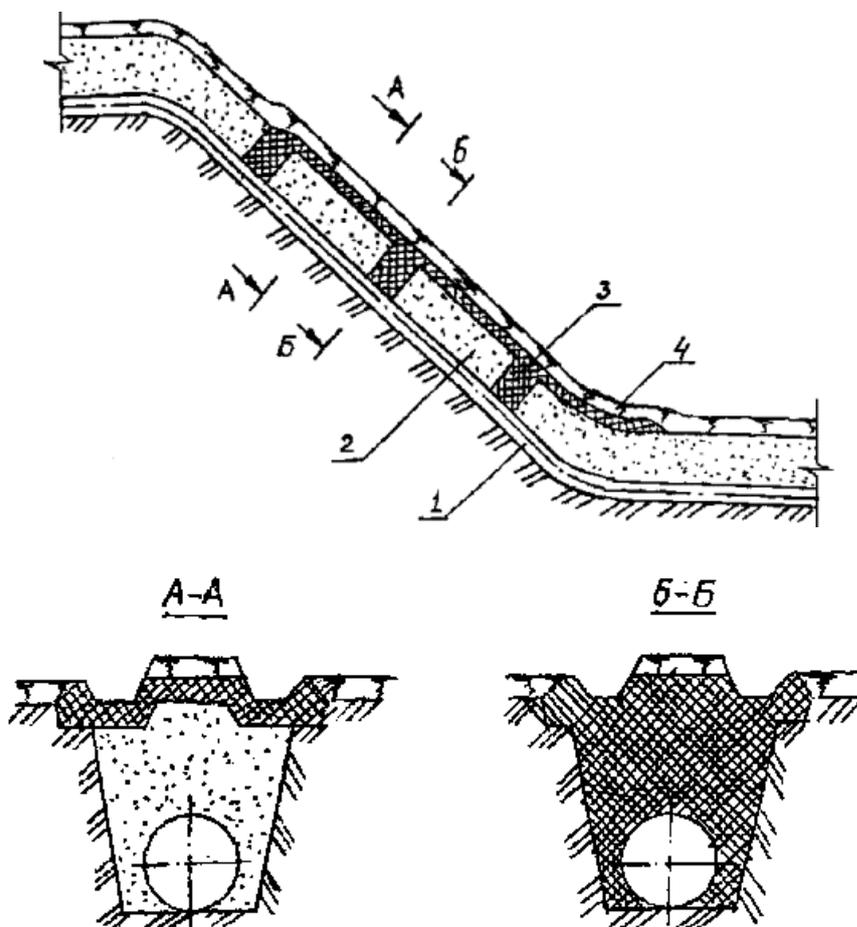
Покрытие-лоток с перемычками на продольном склоне: 1 - трубопровод; 2 - грунт обратной засыпки; 3 - гидрофобизированный грунт; 4 - плодородный слой с семенами трав
